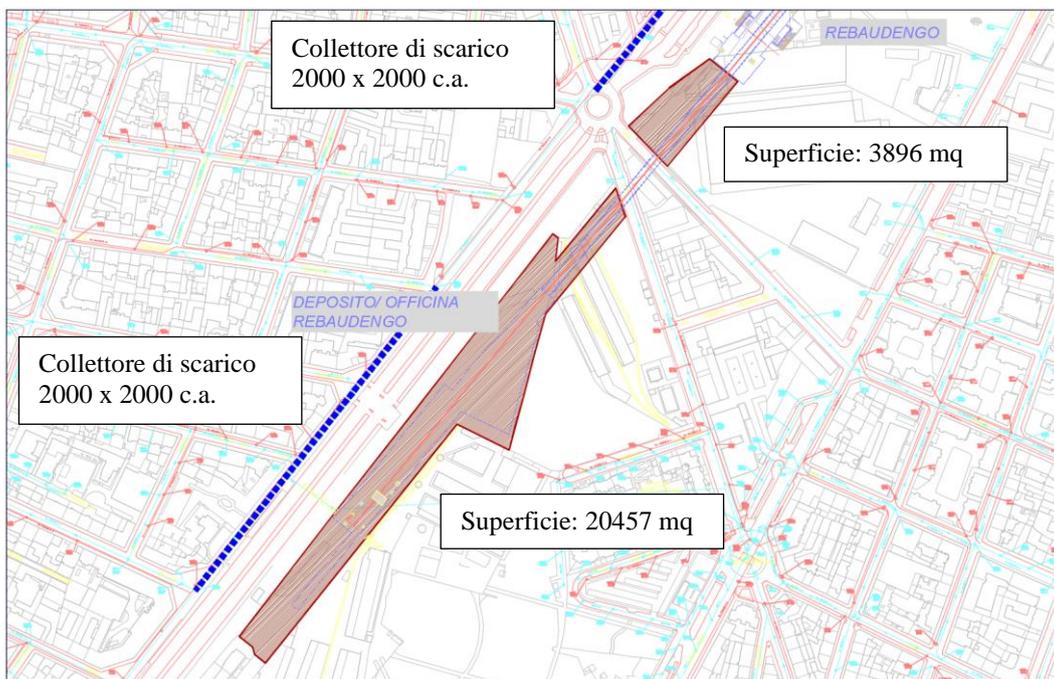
Aree di cantiere – Deposito/officina Rebaudengo – FASE 3
